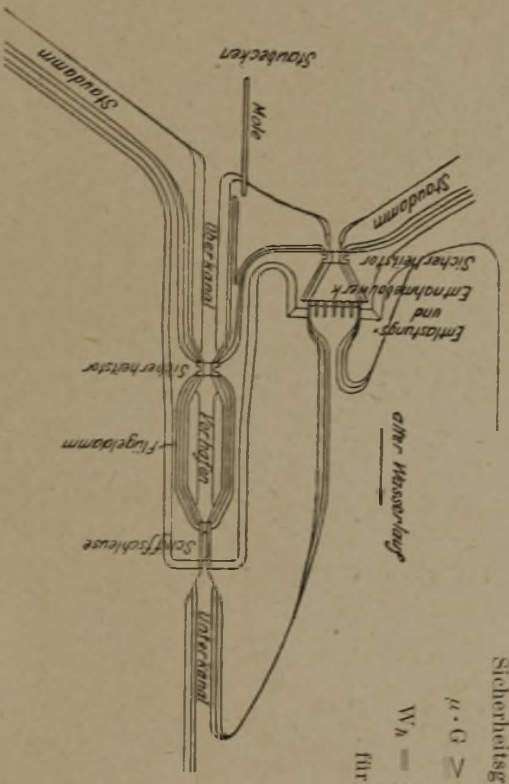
Lageplan des Stauwerkes mit Ausbau für den Schiffsverkehrsverkehr.
